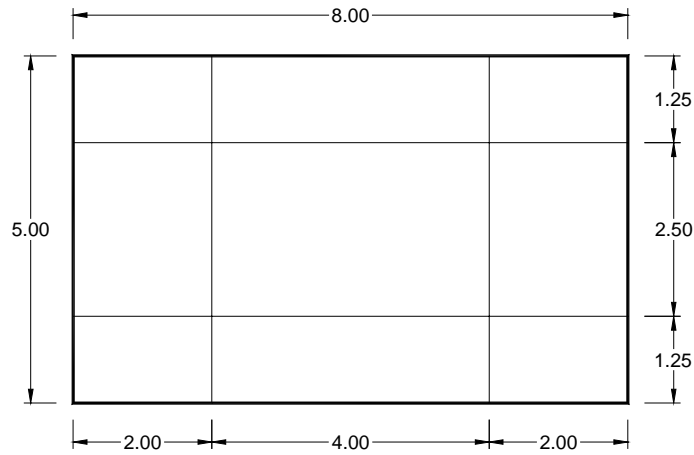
Tablero tipo de losa de cimentación (acotaciones en metros)
